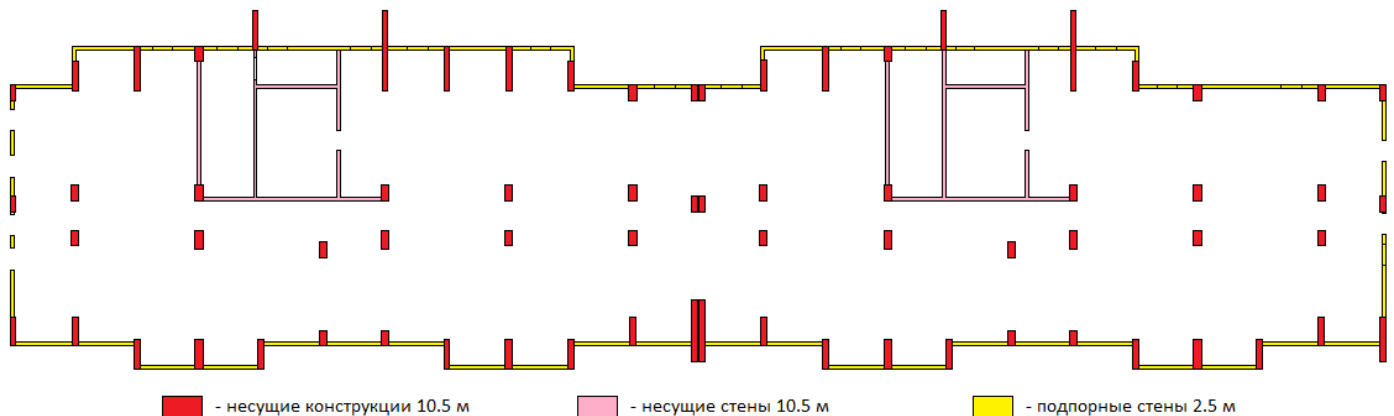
План контролируемых монолитных железобетонных конструкций
